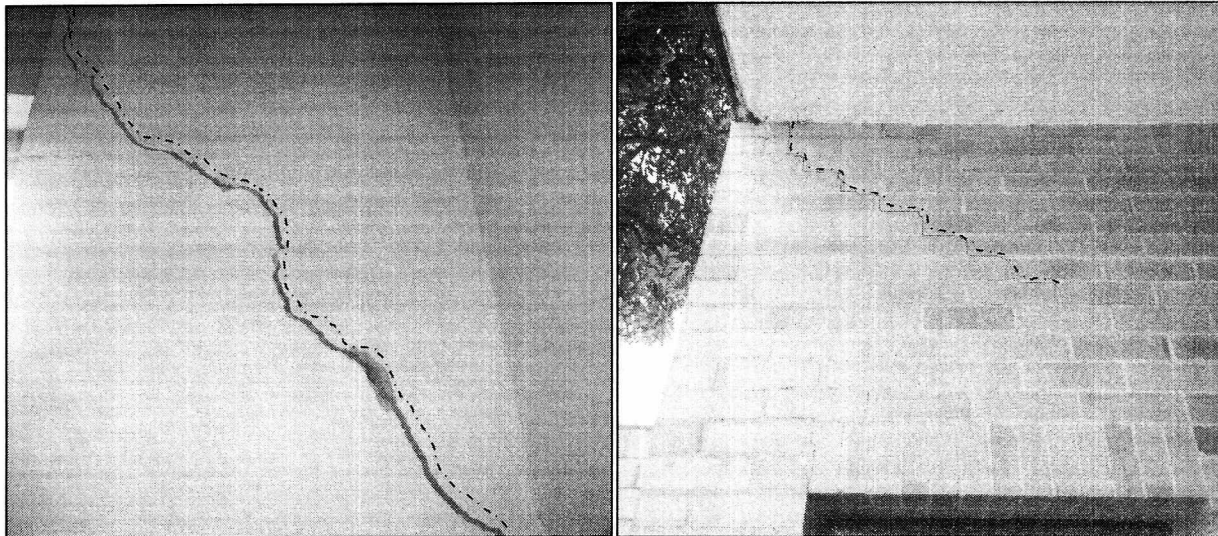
y 15. Vista de las grietas en enchapes y dilatación entre muros donde se observa que no existe traba entre muros de la edificación 2 del Centro Comercial de Educación Media Margarita Bosco ubicado en la Avenida Calle 63 No. 73A-44 del Sector Catastral El Encanto de la Localidad de Engativá
